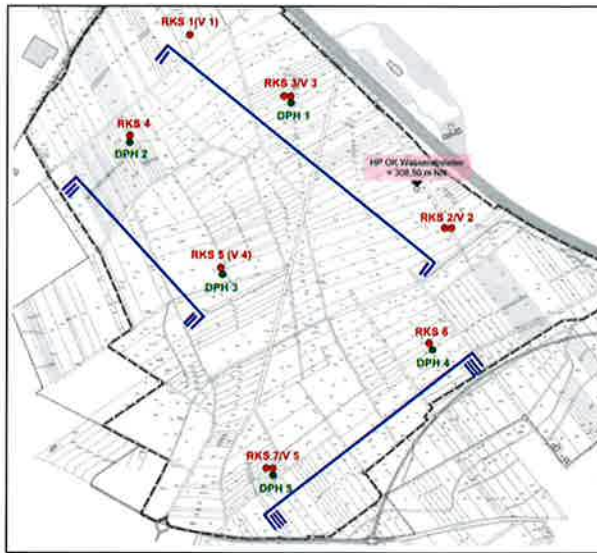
Baugrundgutachten: Lage der Erkundungspunkte <sup>21</sup>
